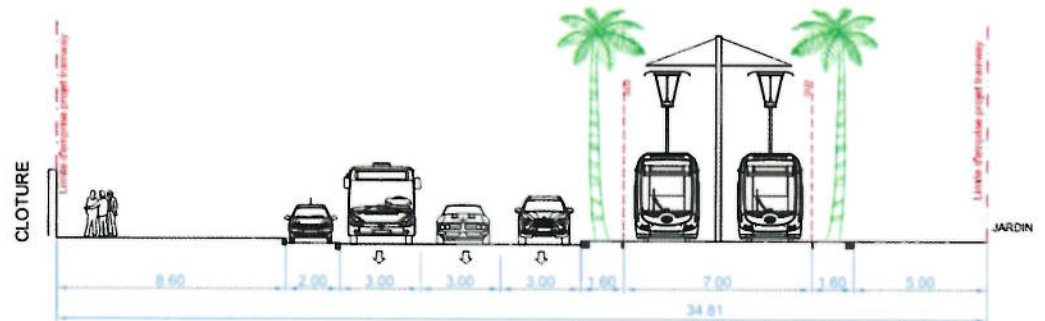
Coupe type en section courante sur Ain Sebaa : insertion latérale
